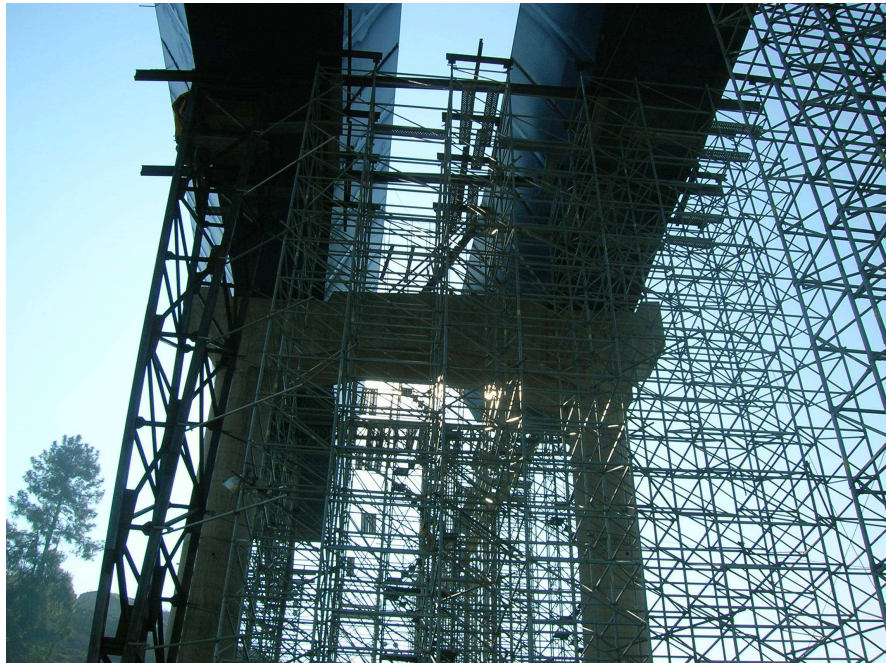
Vista del lugar donde se instalan los apoyos de neopreno
